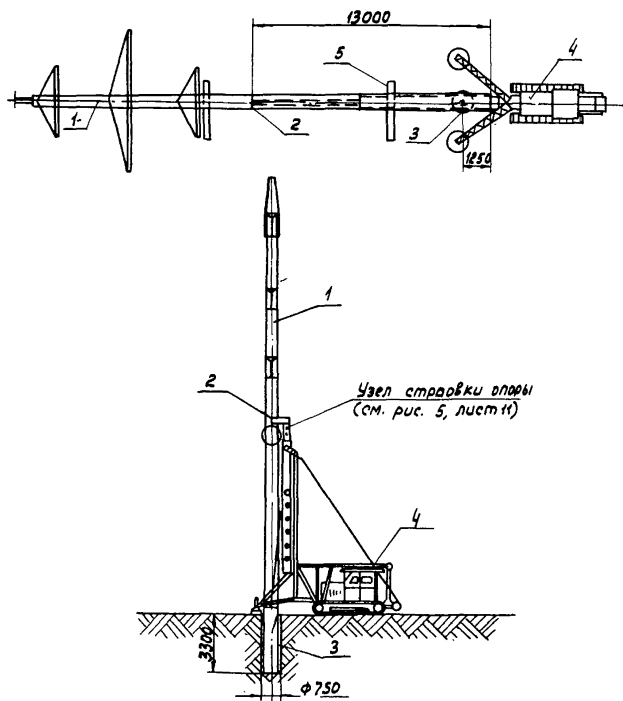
Схема установки железобетонных опор краном КВЛ-8
